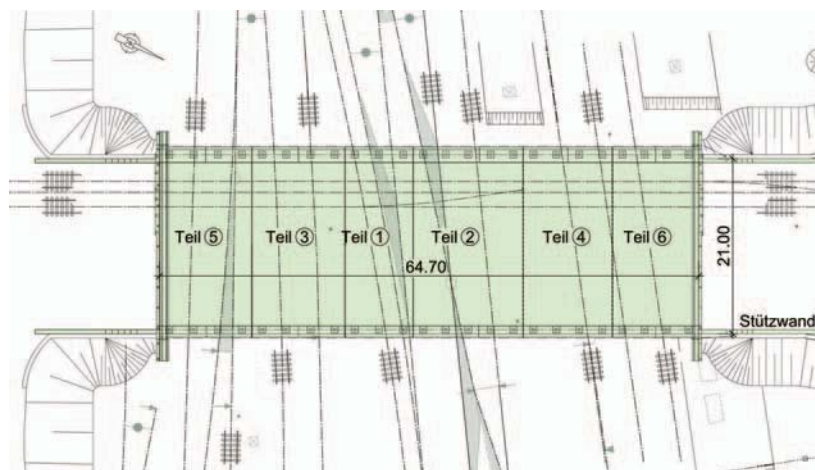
Lageplan Brücke mit Gleislagen und Fugenteilungen
